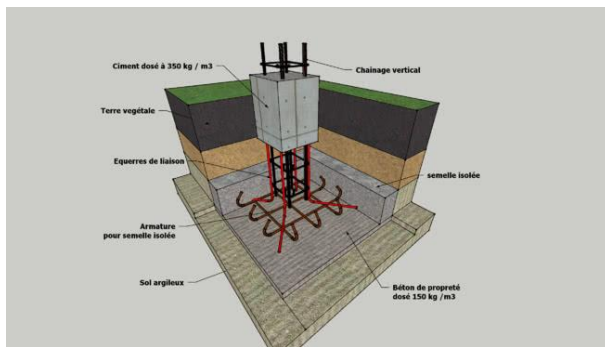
La semelle isolée. [Source : 3dwarehouse.sketchup.com]
